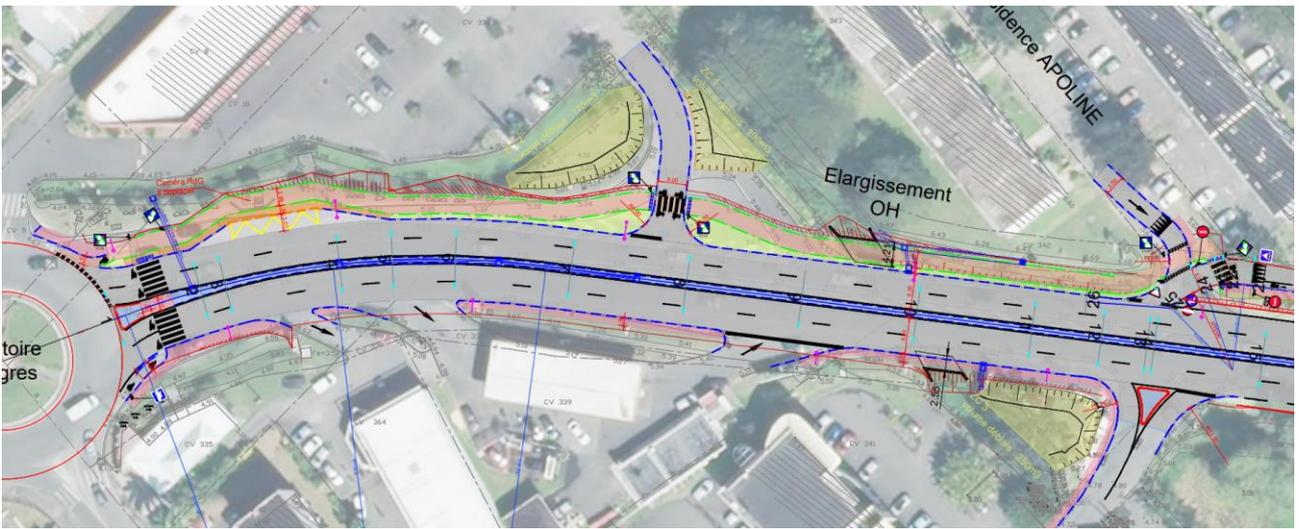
Extraits de plan du projet 1/2 – (Source : Plan AVP, EGIS 12/2022)
